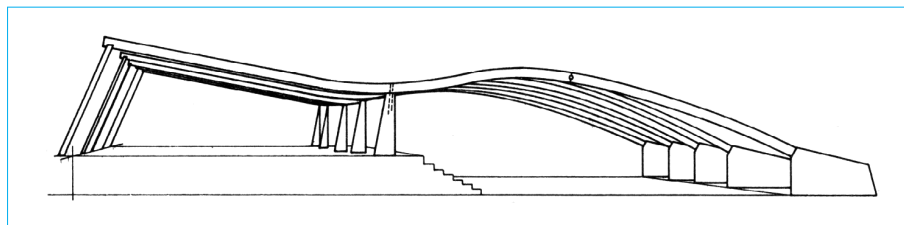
Structure pour hall de sport : arcs de section constante ; moises sur appuis par les poutres droites (portée de 20 à 40 m et plus entre appuis)
